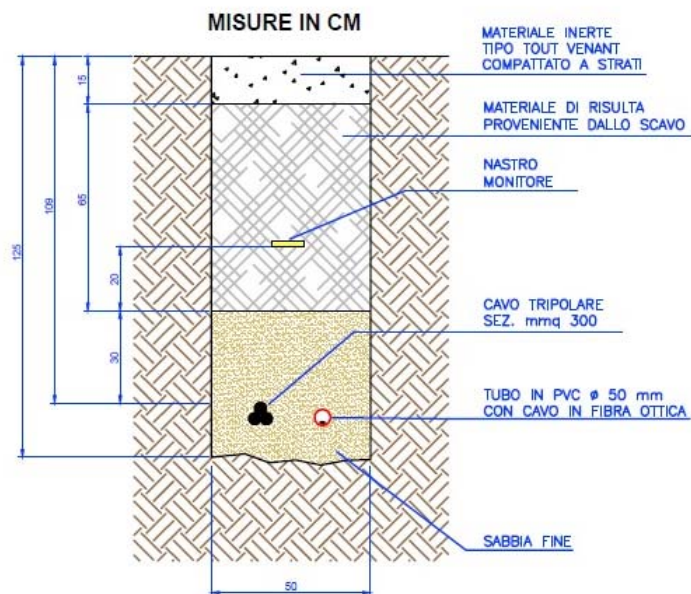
Sezione tipo cavidotto tripolare più fibra ottica su strada sterrata infraparco
